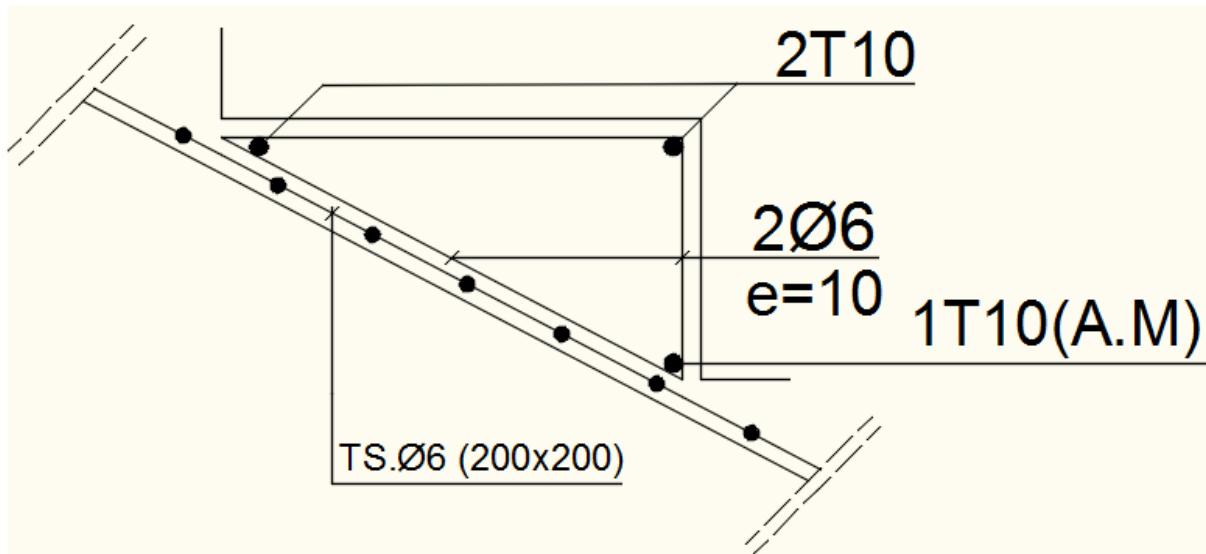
Coupe transversale sur la marche porteuse.
